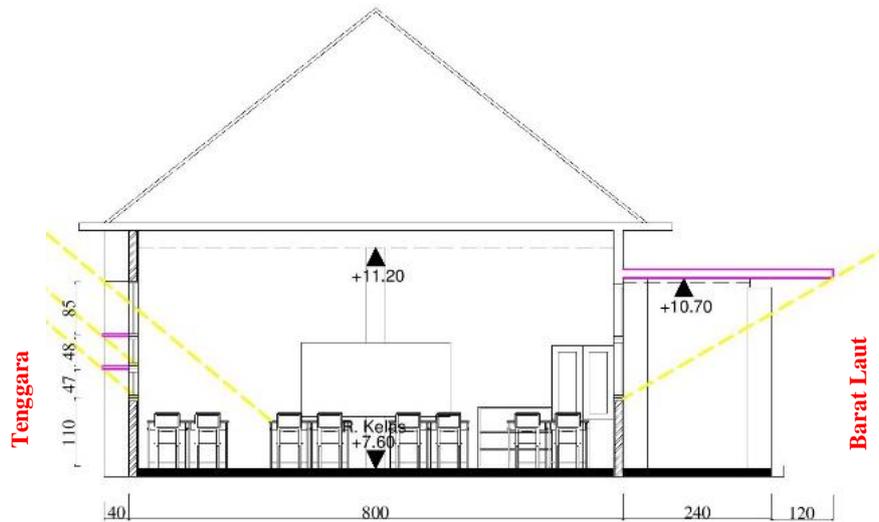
Tampak Tenggara dan Barat Laut Ruang Alternatif 1 Rekomendasi Eksternal II Ruang Kelas IPA
